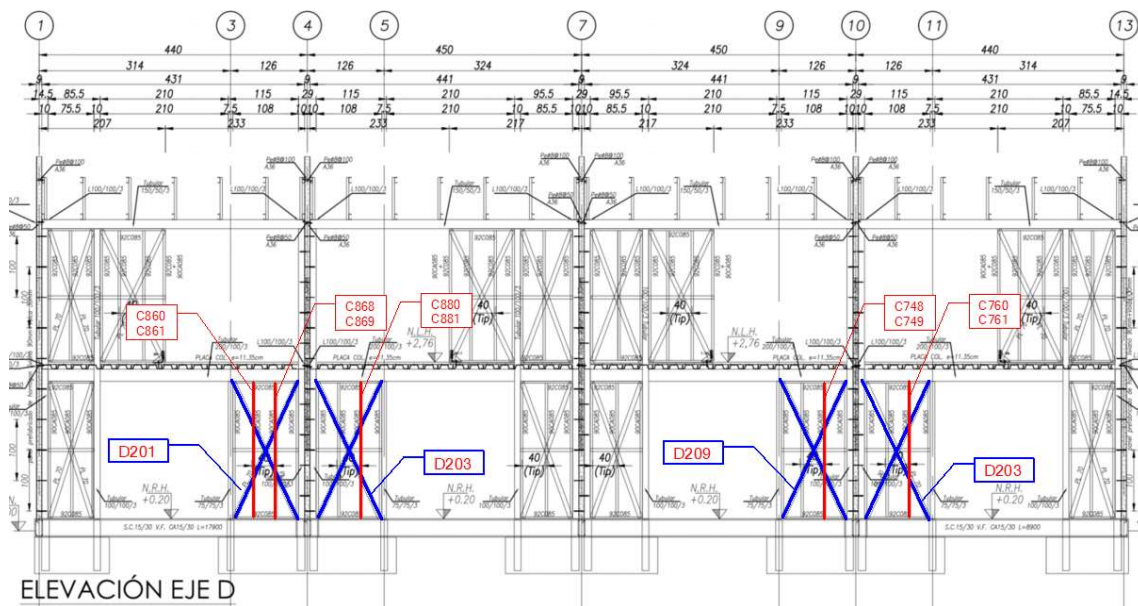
Elevación eje D, etiqueta de elementos de paneles Metalcon.
